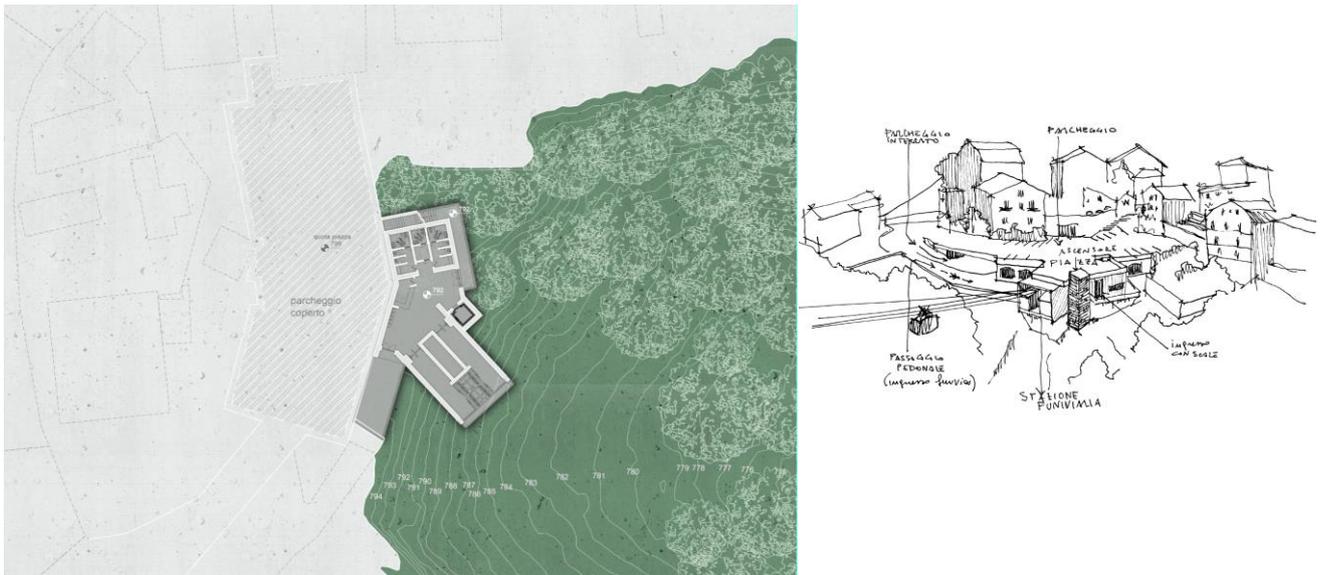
Pianta dell'HUB 3. A sinistra: uno schizzo progettuale.
